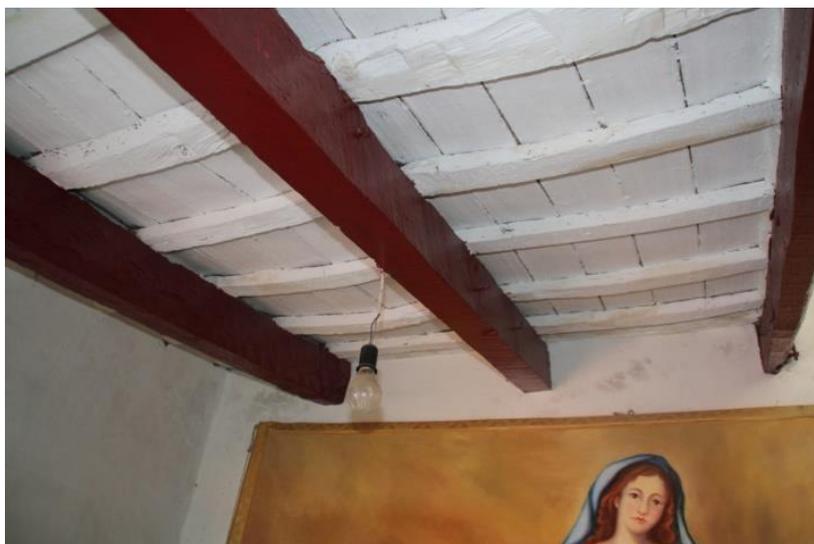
Estado de la cubierta de altillo 3 (Fuente propia)
